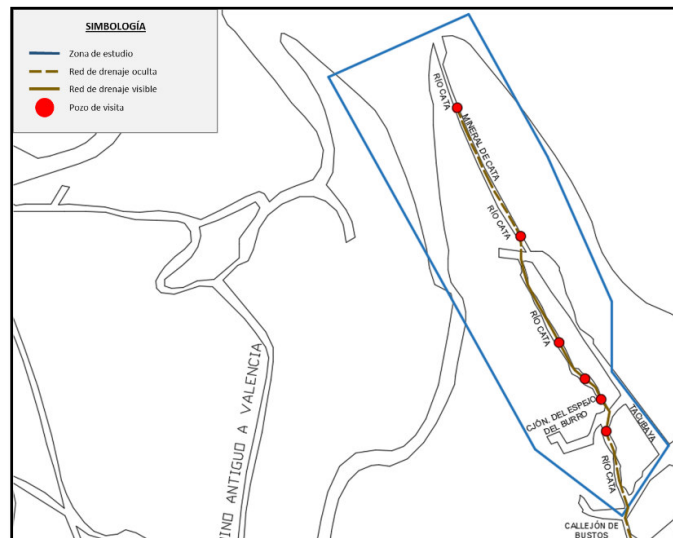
Red de drenaje en la zona de estudio. Elaboración propia con datos de levantamiento en campo.
